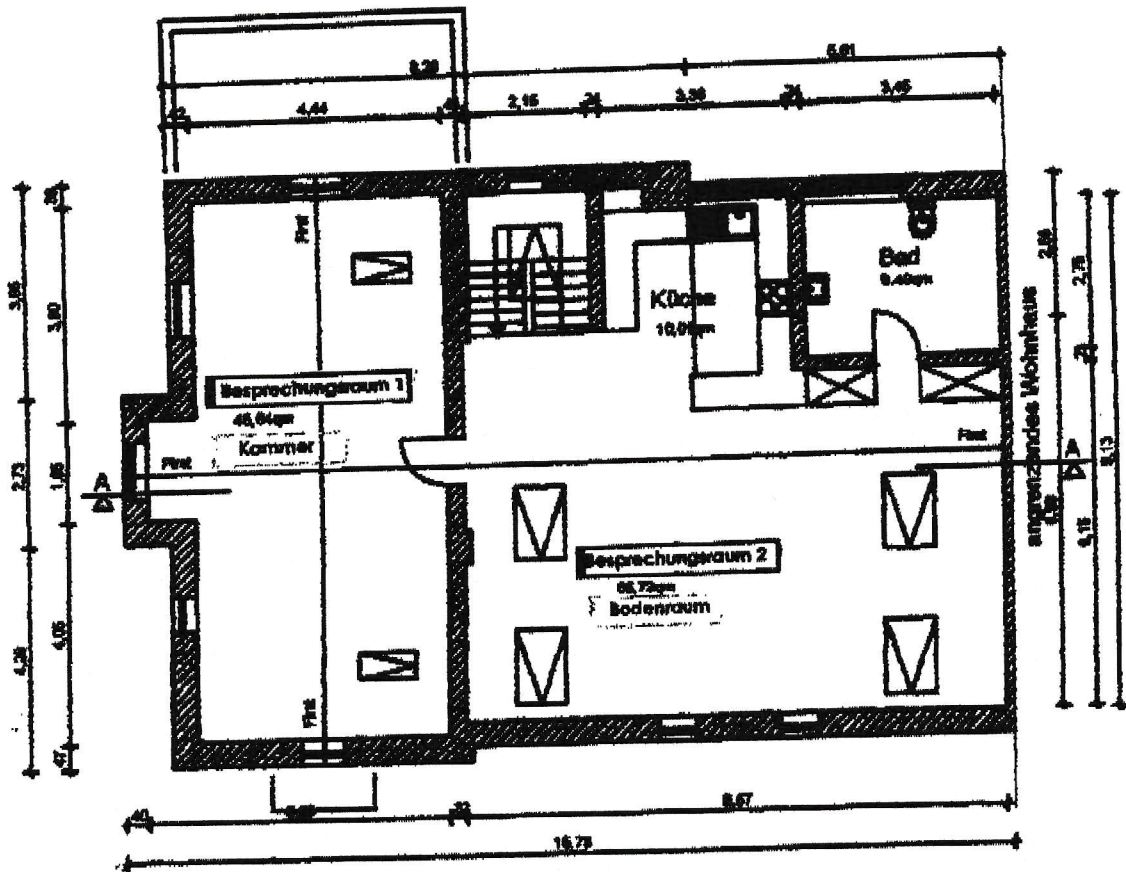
Grundriss 2. Obergeschoss, Hostatostrasse 26, 65929 Frankfurt am Main
